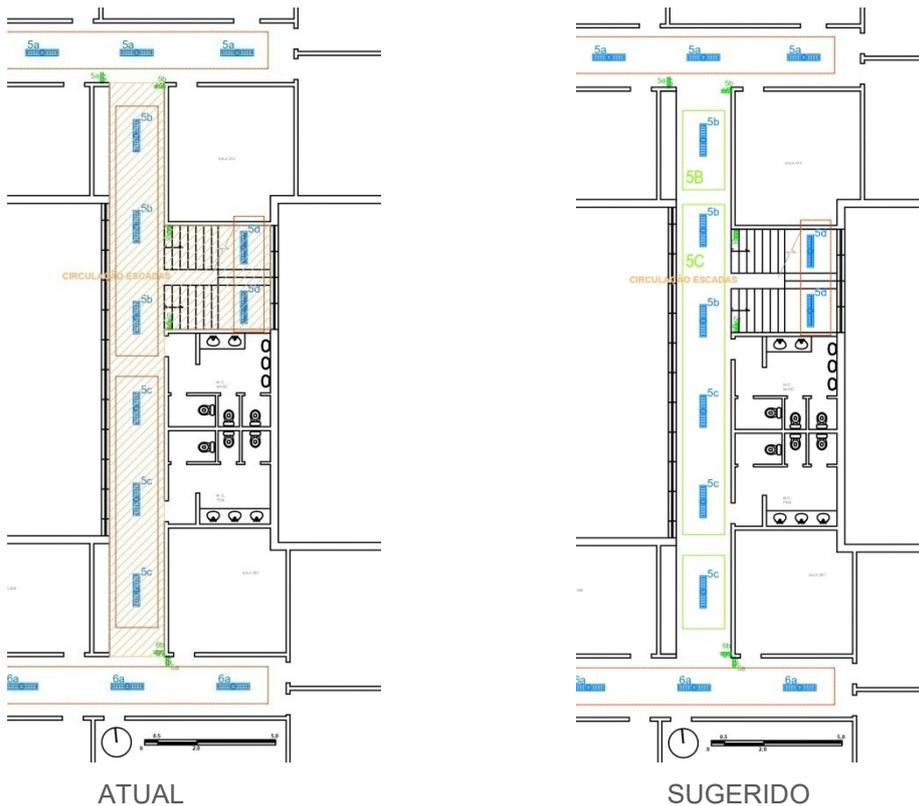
Planta de distribuição dos sistemas de acionamento e iluminação da circulação próxima às escadas no 1º pavimento. Fonte: Redesenho dos autores.
